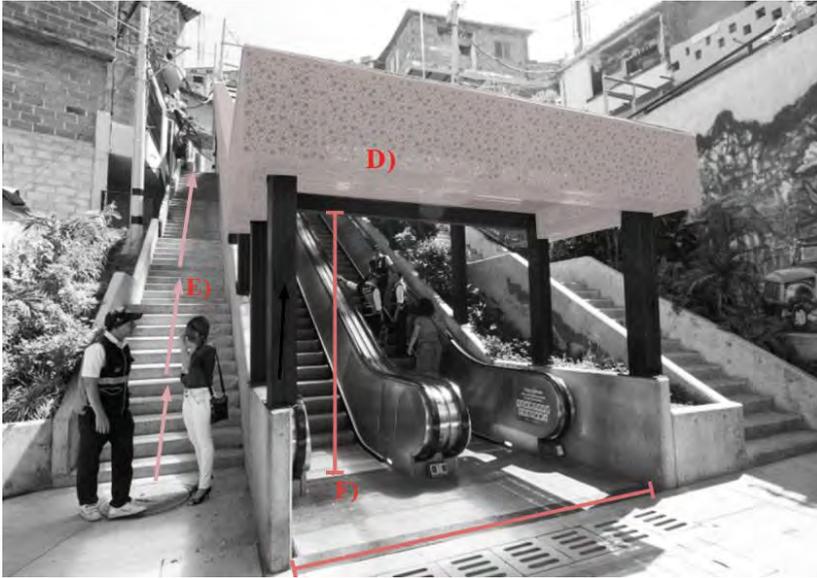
Ingreso al proyecto de escaleras eléctricas "Medellín"
